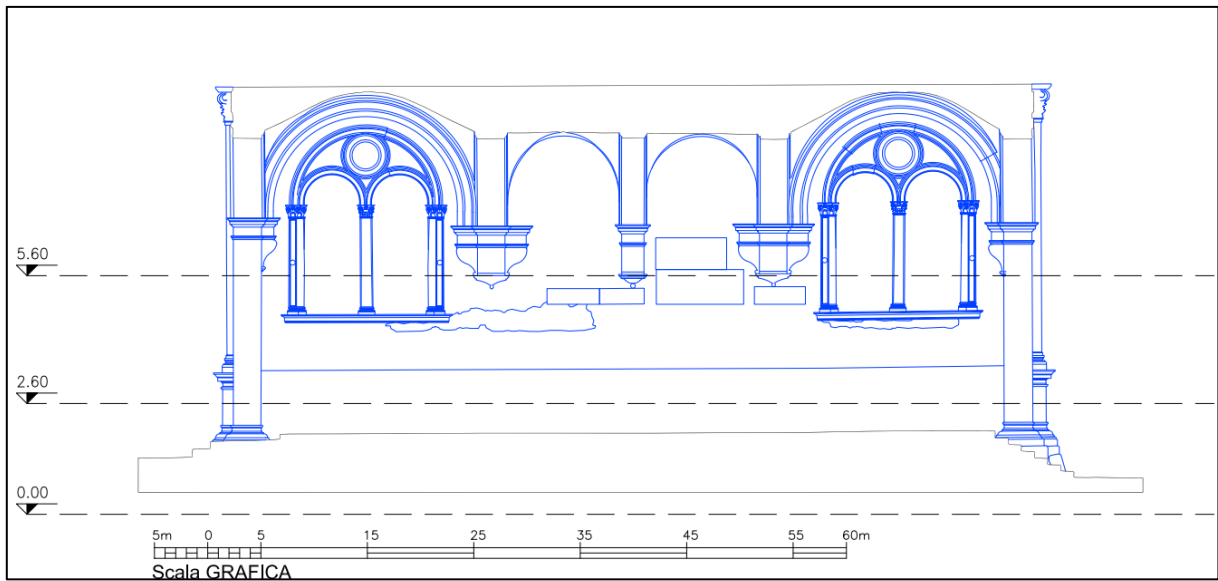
Sezione 2 – sezione verticale e vista prospettica
